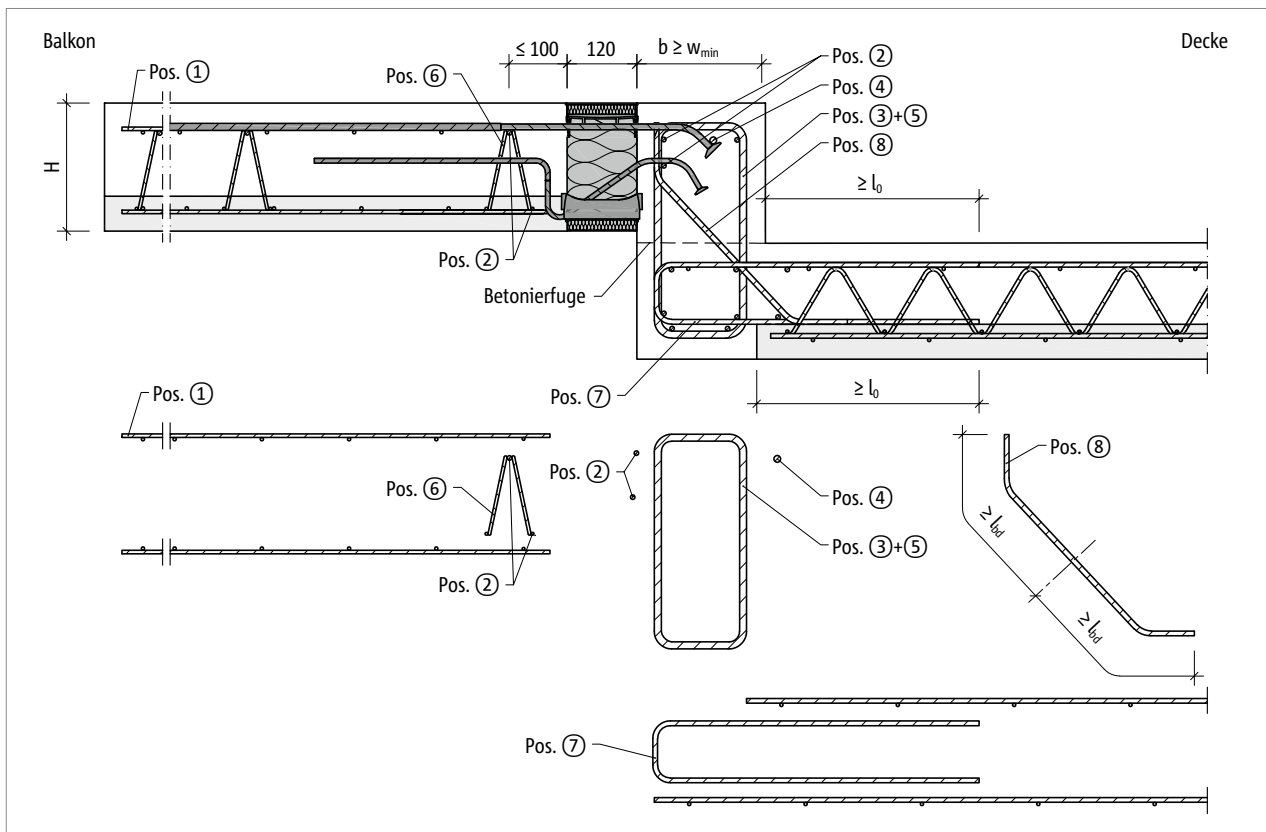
Schöck Isokorb® XT Typ KL-O-F: Bauseitige Bewehrung für Balkon mit Höhenversatz nach oben
